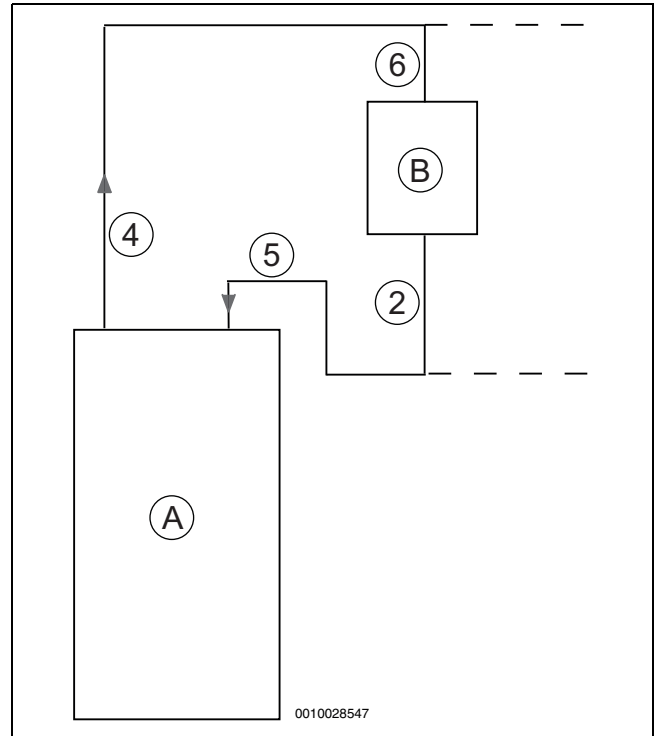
Prinzipskizze – Pufferspeicher mit Wärmepumpe
